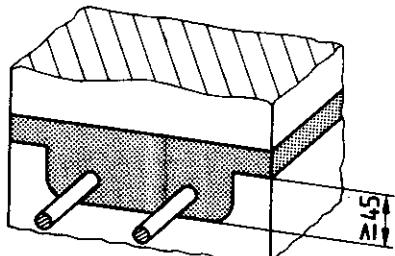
Horizontale Bewehrung in tröpfelförmigen Formsteinen (Prinzipskizze)
